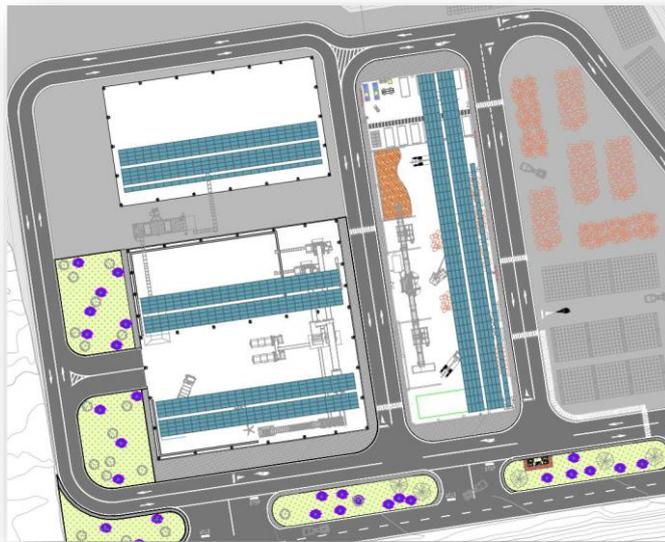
Implantación prevista de los paneles fotovoltaicos.
